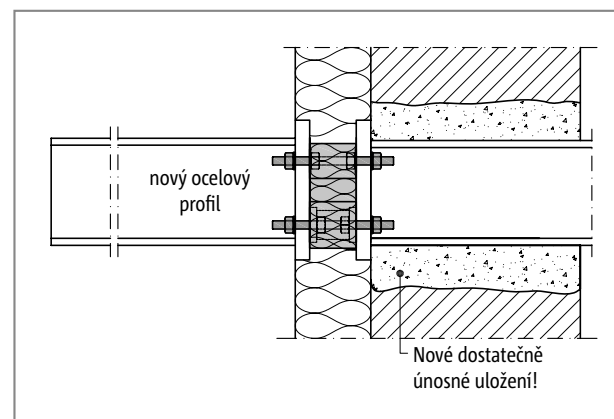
Schöck Isokorb® T typ S-N a T typ S-V: Napojení ocelové konstrukce na železobeton
